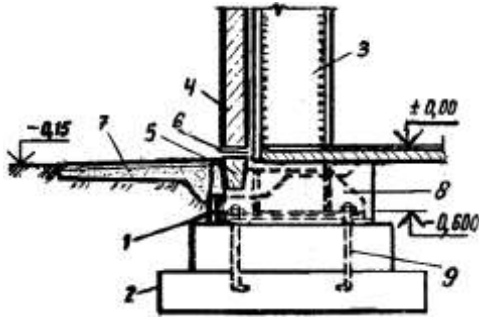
Спирання сталі суцільної колони на фундамент: 1 – під бетонка; 2 – фундамент; 3 – стальна колона крайнього ряду; 4 – стінова панель; 5 – фундаментна балка; 6 – гідроізоляція; 7 – вимощення; 8 – траверса колони; 9 – анкерні болти замонтовані в фундаменті.
